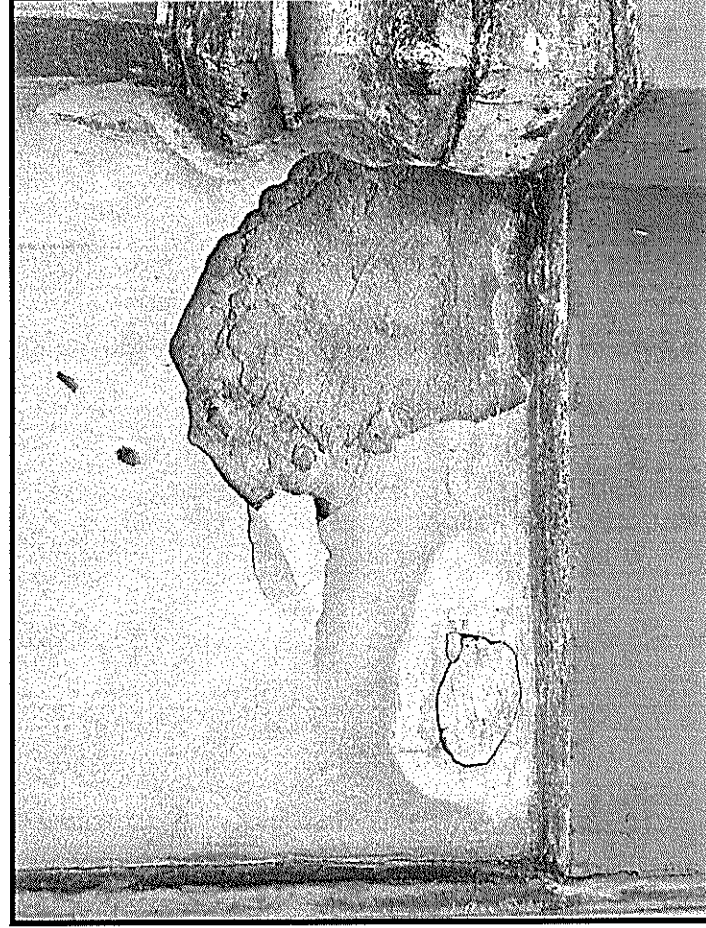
Stan zachowania elewacji frontowej (zachodniej) kościoła w Regnowice.
